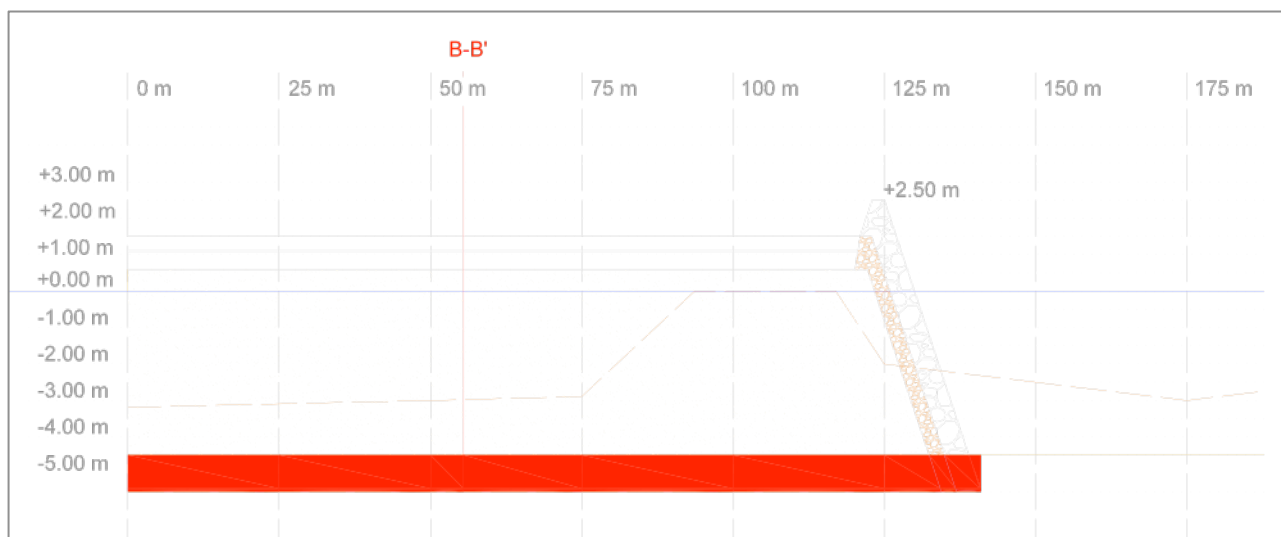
Sección longitudinal dragado del muelle y contradique Este
